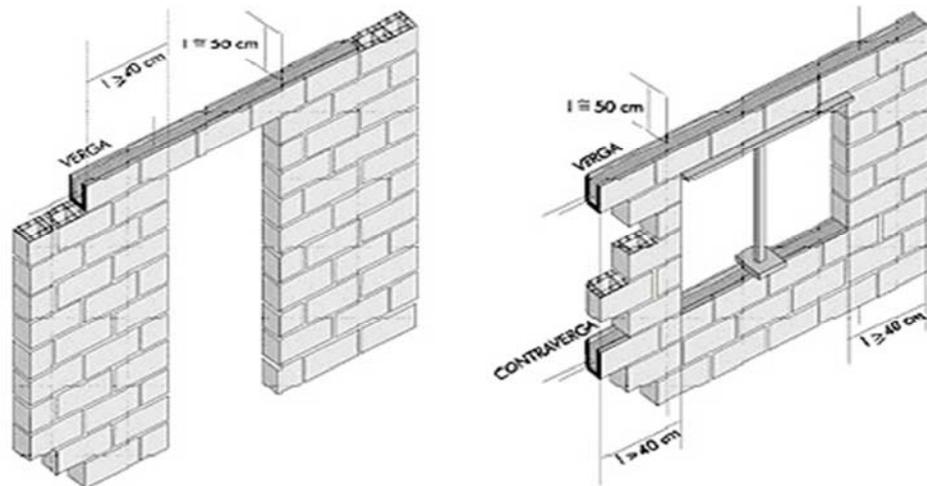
Vergas e contravergas executadas em blocos tipo canaleta
